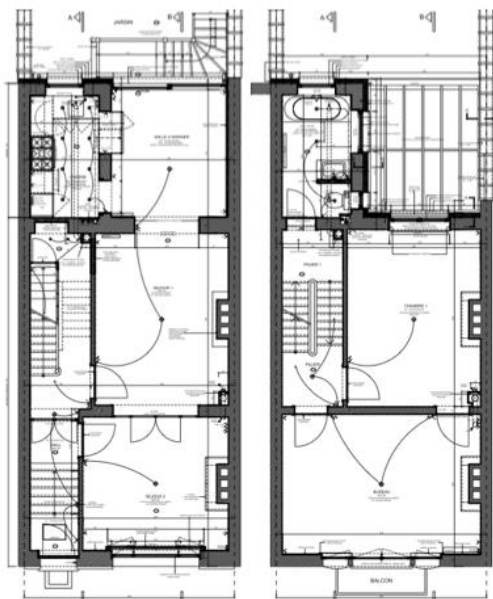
Plans du rez-de-chaussée et du 1er étage
